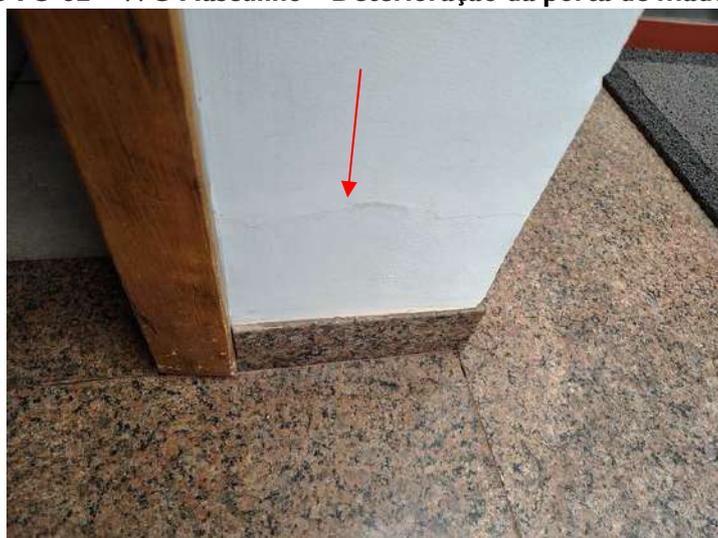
WC Masculino – Fissura ao lado direito da porta de entrada
